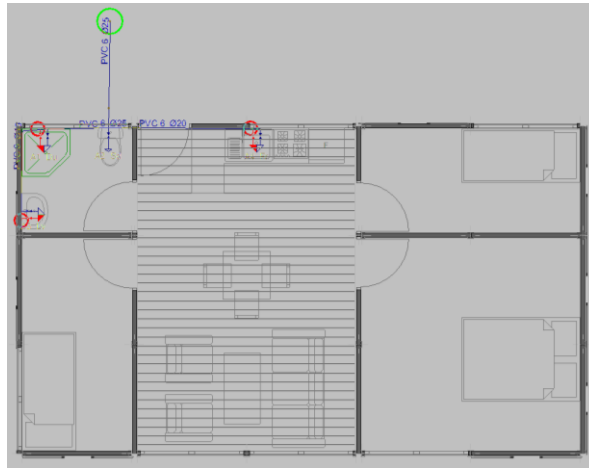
Conexión de fontanería de la vivienda de 1 planta, vista 2D
